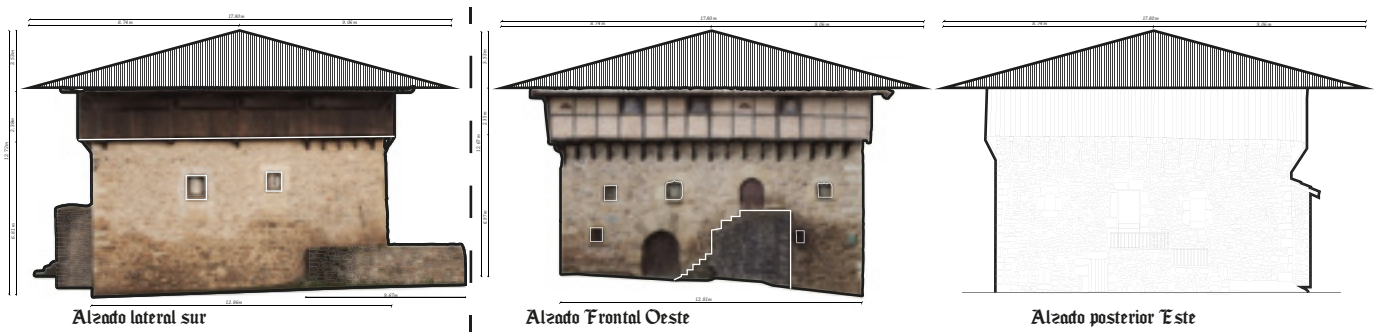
Alzados caserío Aranguren y alzados Torre Aranguren
